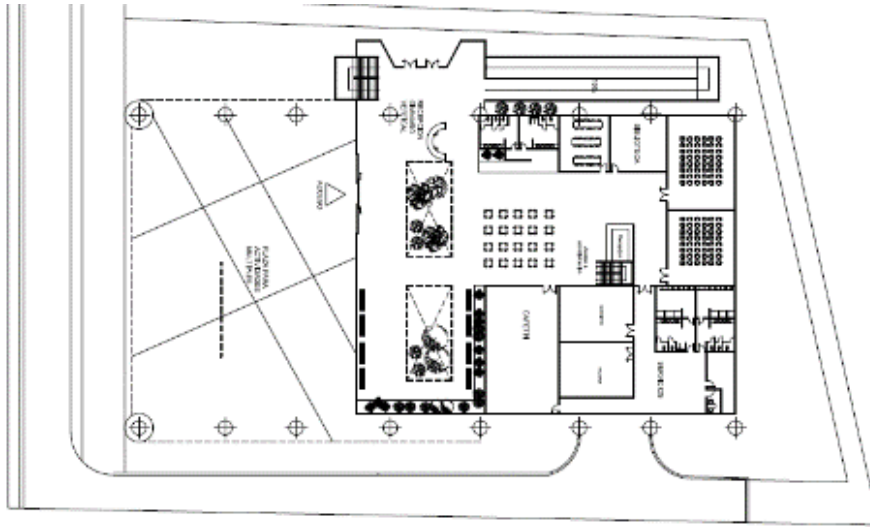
Imagen de Planta baja conjunto del Gimnasio Vertical. *Villamizar y otros (2017)
